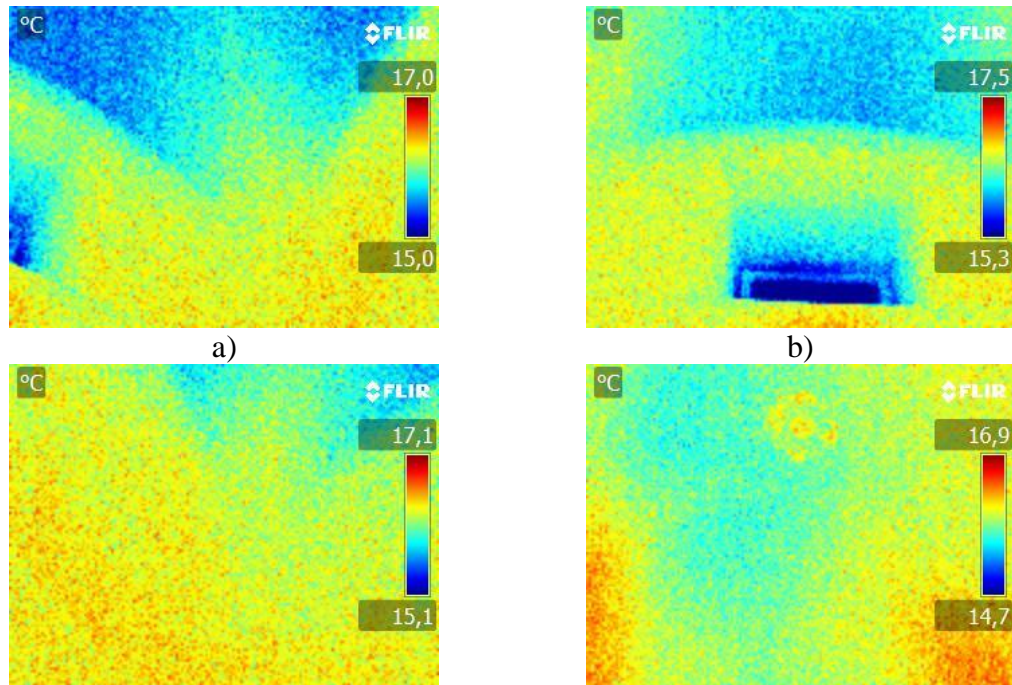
Termografía salas bajo cubierta 1, adyacente a la capilla de la Comunión: a) Conexión del arco toral con la fachada exterior, en zona de acceso a la capilla de la Comunión, b) Conexión fachada con cubierta en zona de ventana, c) Segunda esquina del muro de fachada, equivalente a la imagen (b), d) Vista general del a cubierta desde abajo.
